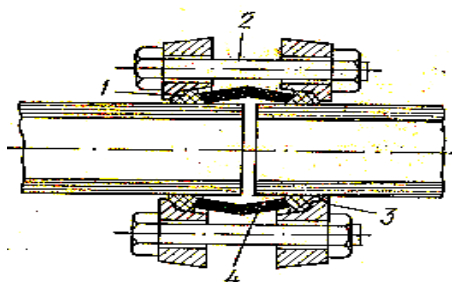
Îmbinarea tuburilor din asbociment cu mufă și flanșă din fontă: 1 – inel din cauciuc; 2 – șuruburi; 3 – flanșe; 4 – bucușă din fontă
